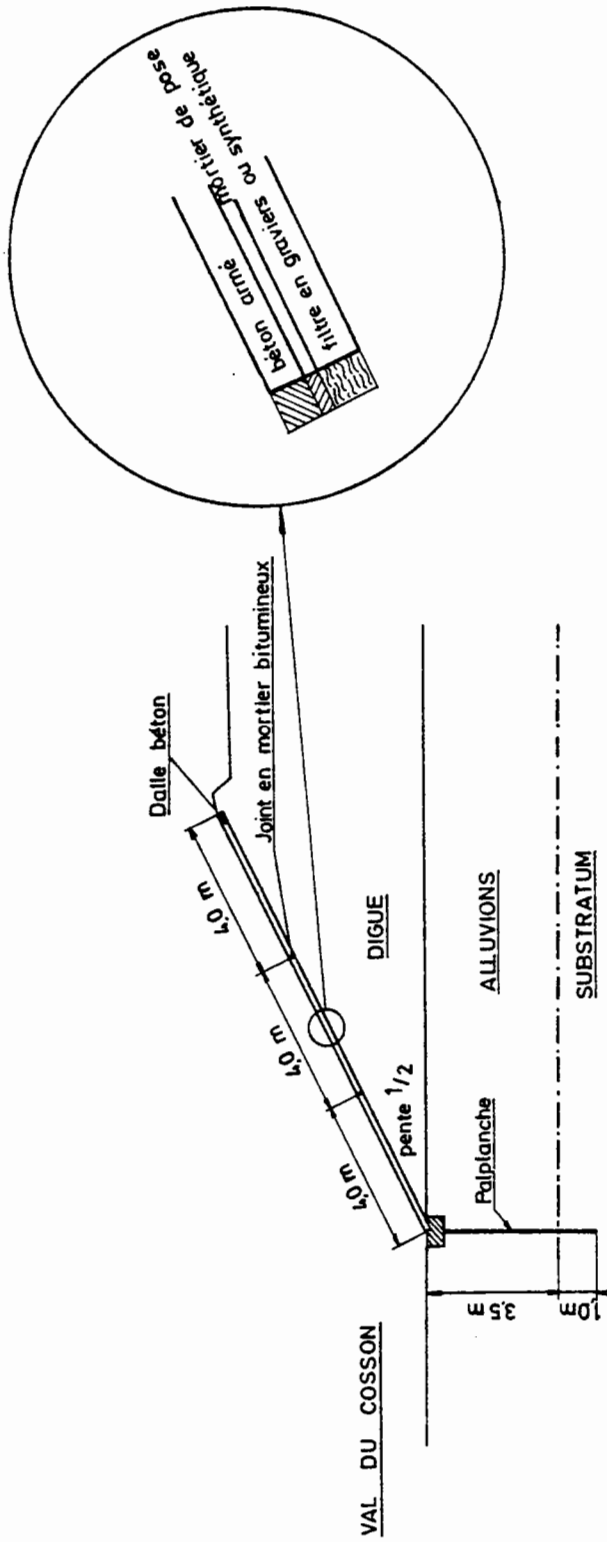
Schéma de principe d'un étanchement amont au moyen d'un rideau de palplanches et de dalles béton.
